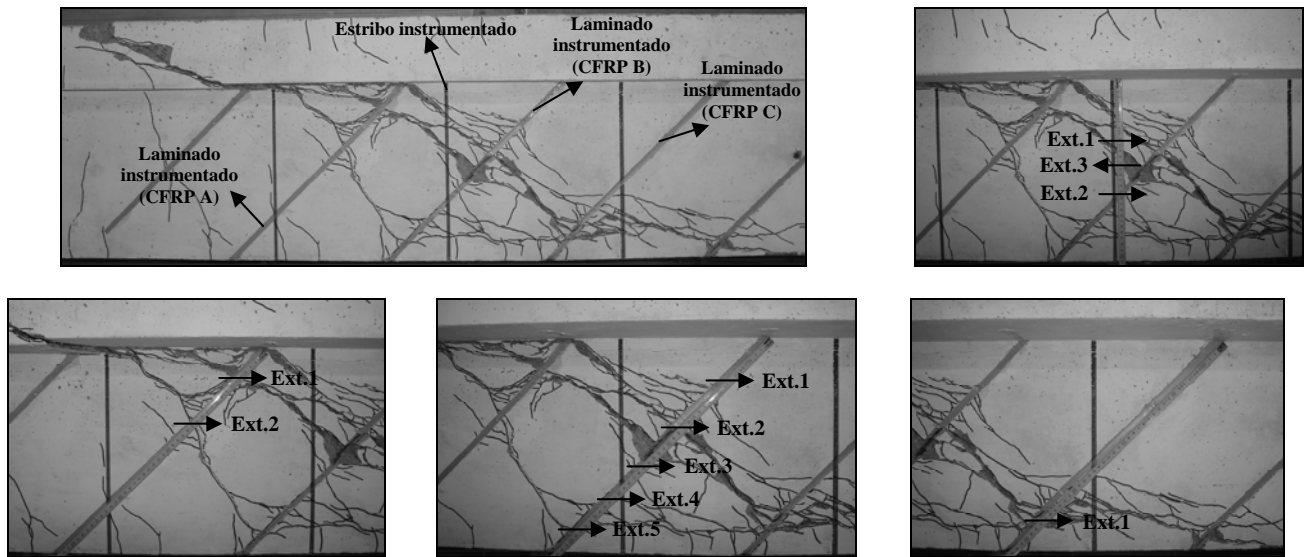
Localização dos extensómetros no laminado e estribo instrumentados da viga 3S-5LI45F1-D.
